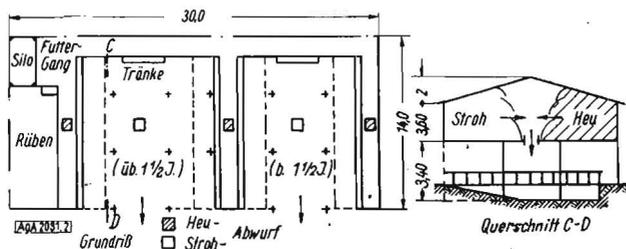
Jungvieh-Offenstall mit deckenlastiger Lagerung auf der Grundlage des Bergeraumes für 90 Kühe
